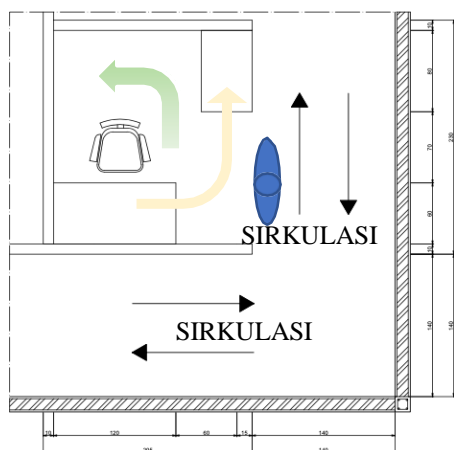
Tipe Layout Dekat Area Bukaannya Tipe G
